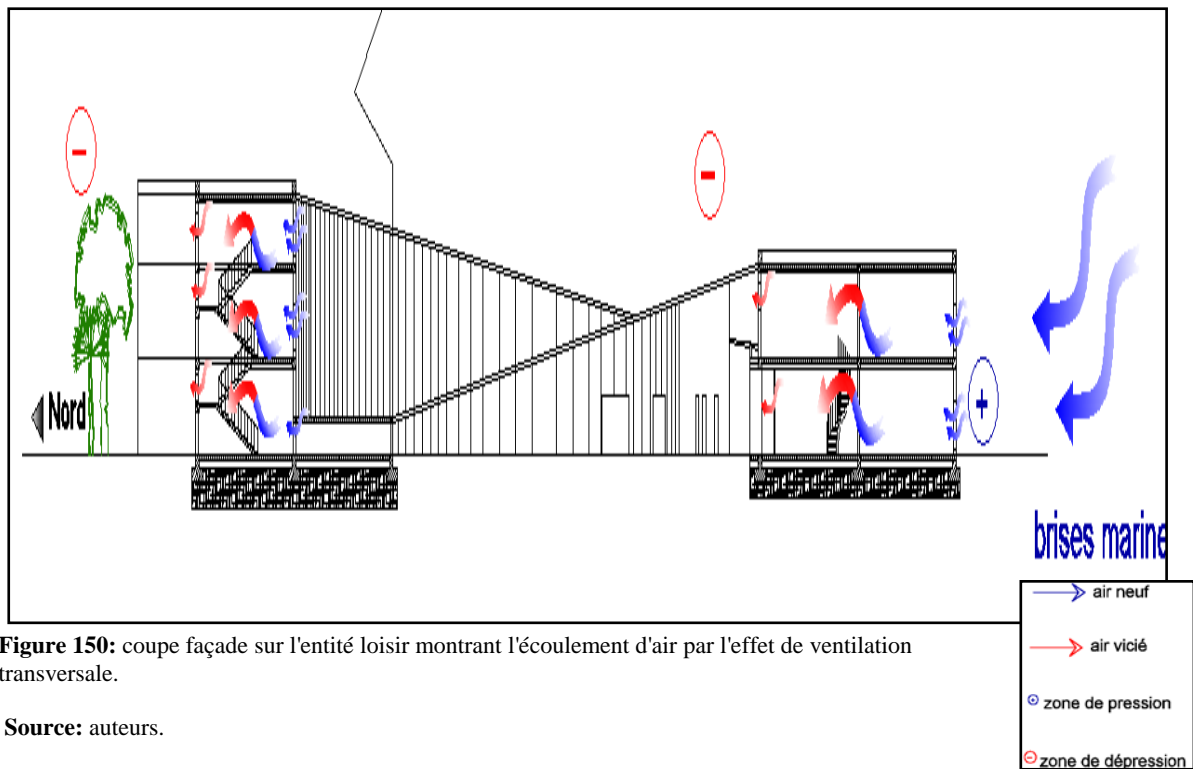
coupe façade sur l'entité loisir montrant l'écoulement d'air par l'effet de ventilation transversale.
